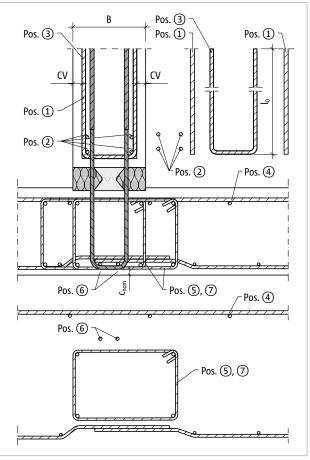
Schöck Sconnex® type W-NT-B : renforcement sur site dans le cas d'un ancrage de l'effort de traction ; poutre noyée comme exemple
